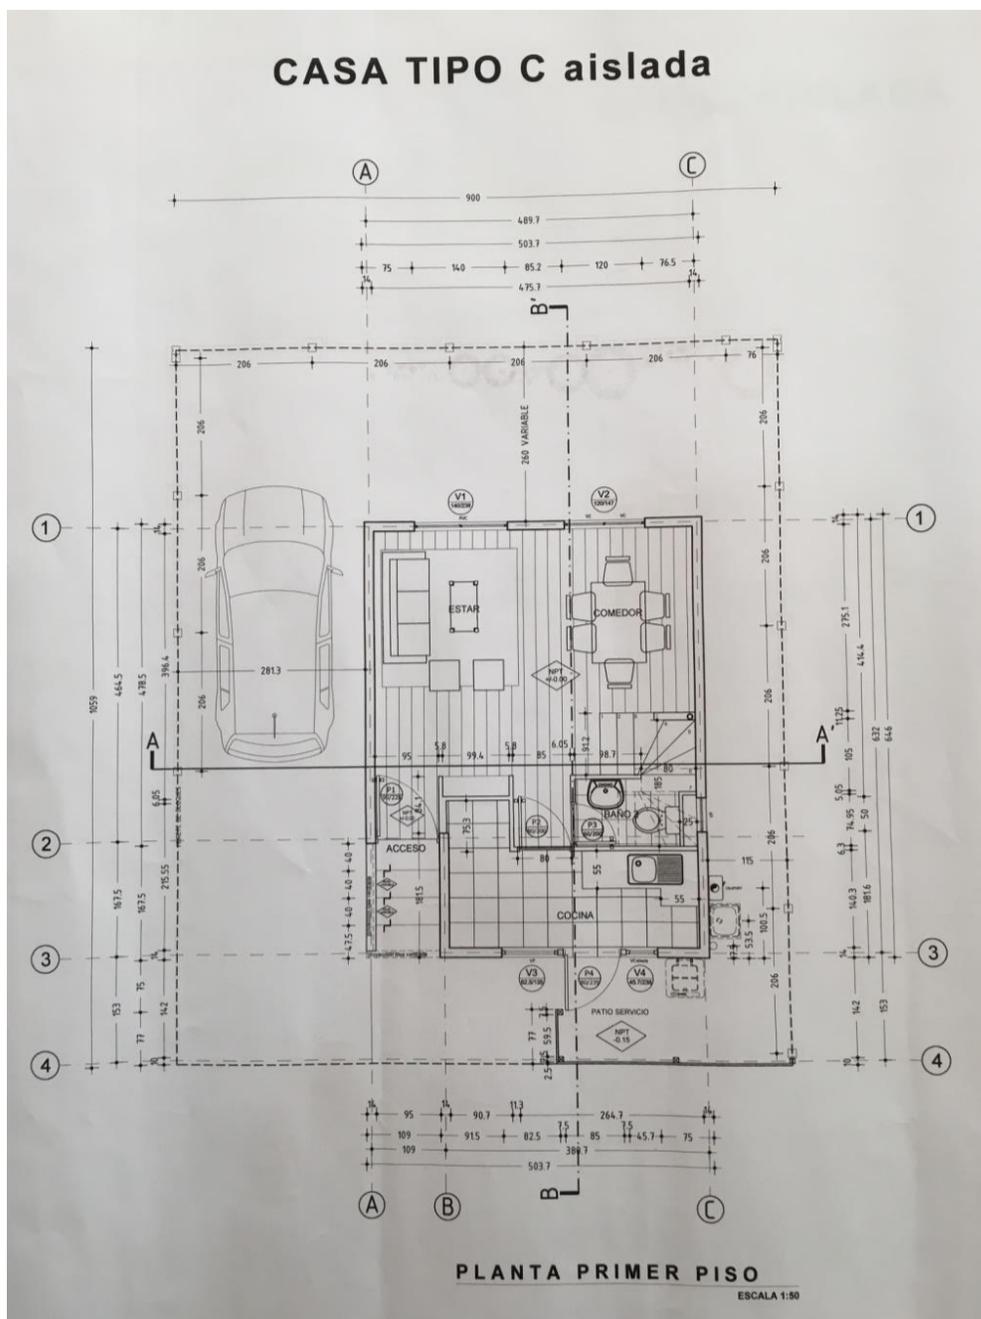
Planta primer piso casa tipo C Aislada.
